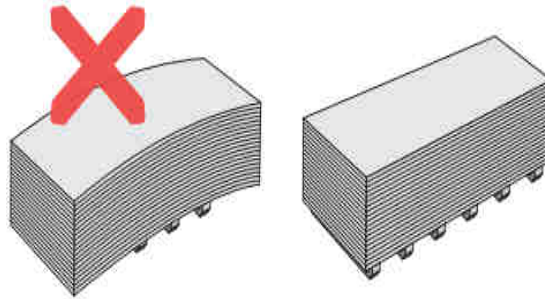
Empilhamento correto (Associação Brasileira do Drywall, 2016)
